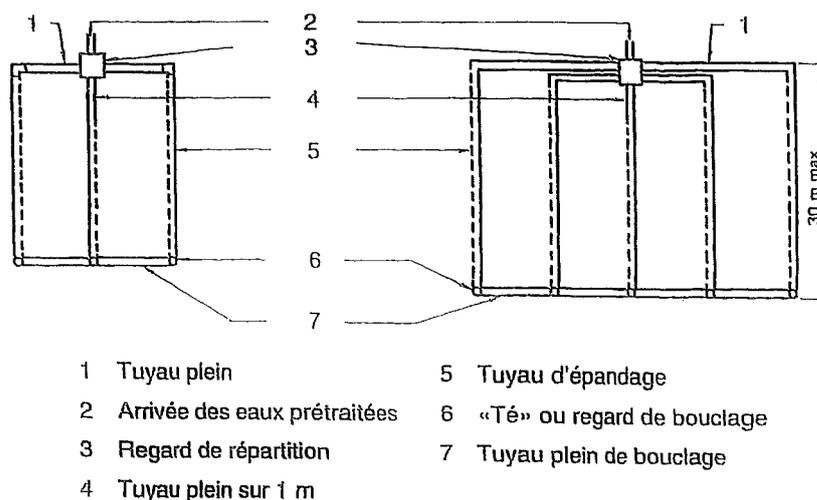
Vues en plan ; exemples à 3 et 5 tranchées
